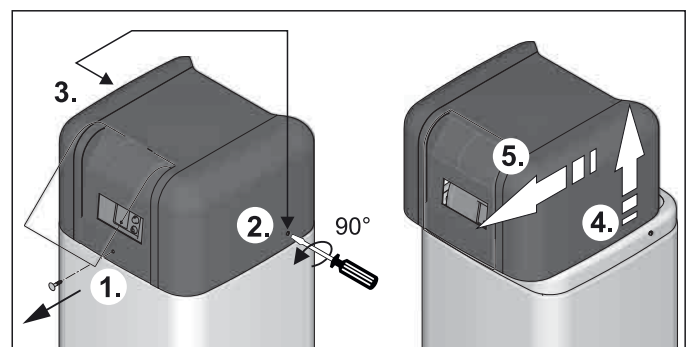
Dévisser / desserrer les vis, soulever la hotte de recouvrement à l'arrière et l'enlever par l'avant.
